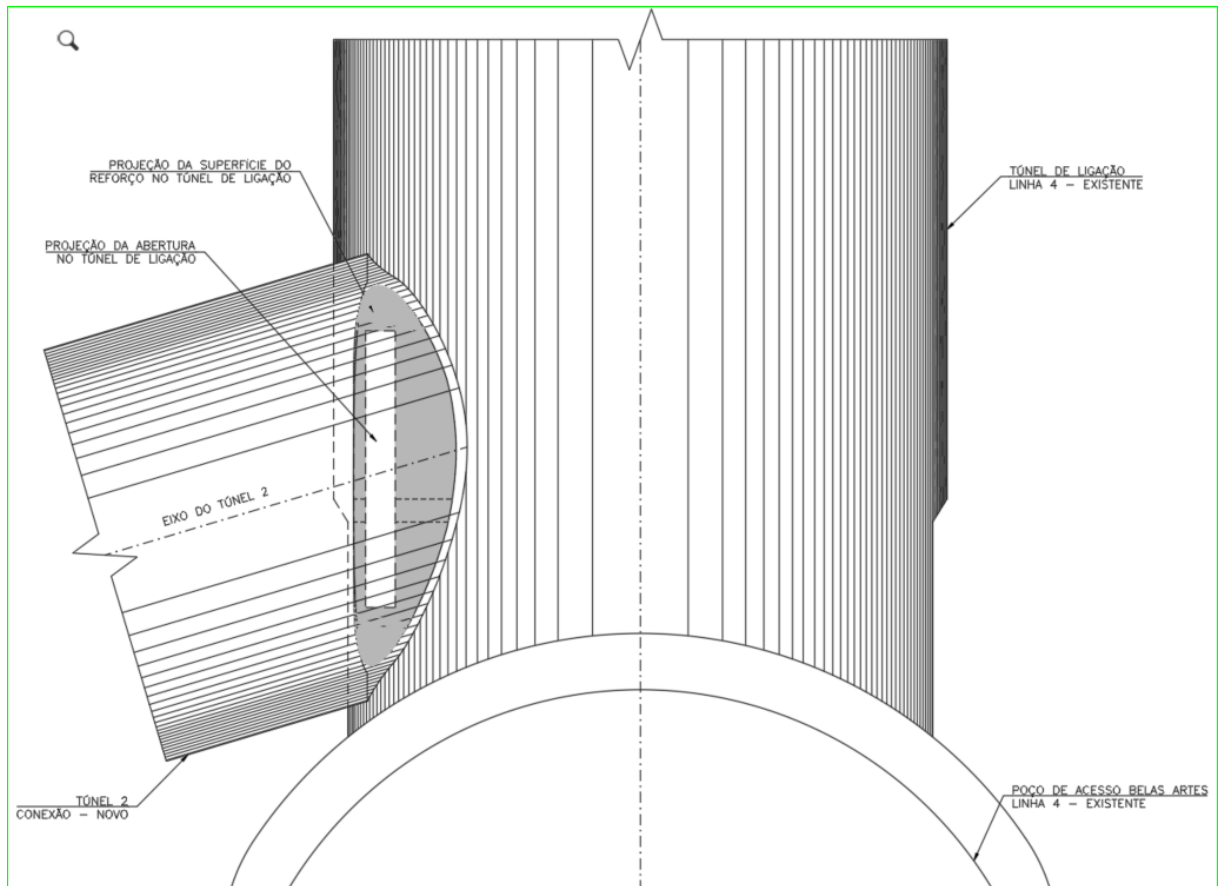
Planta apresentando abertura e reforço no túnel de ligação existente da estação Paulista.
